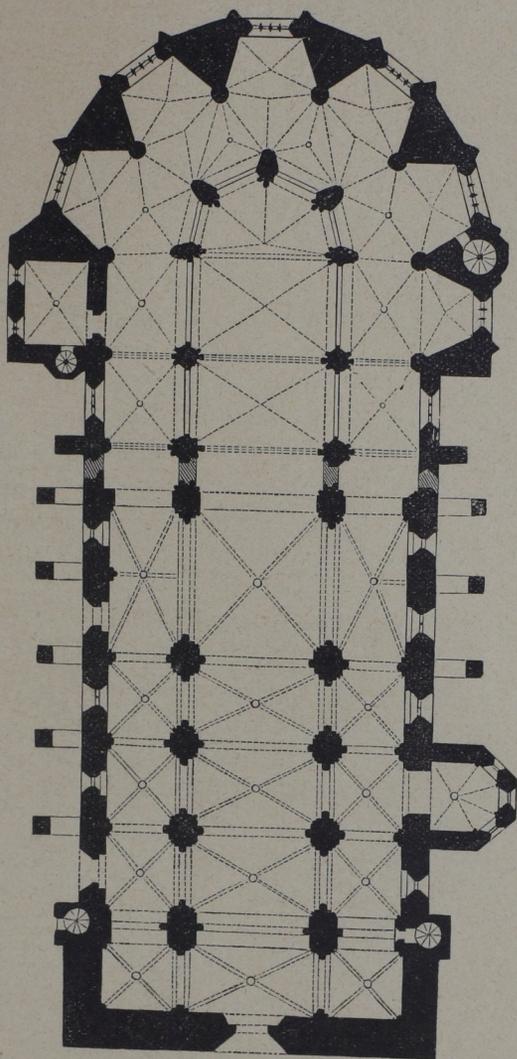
Grundriss der Bartholomäuskirche in Kolin.
